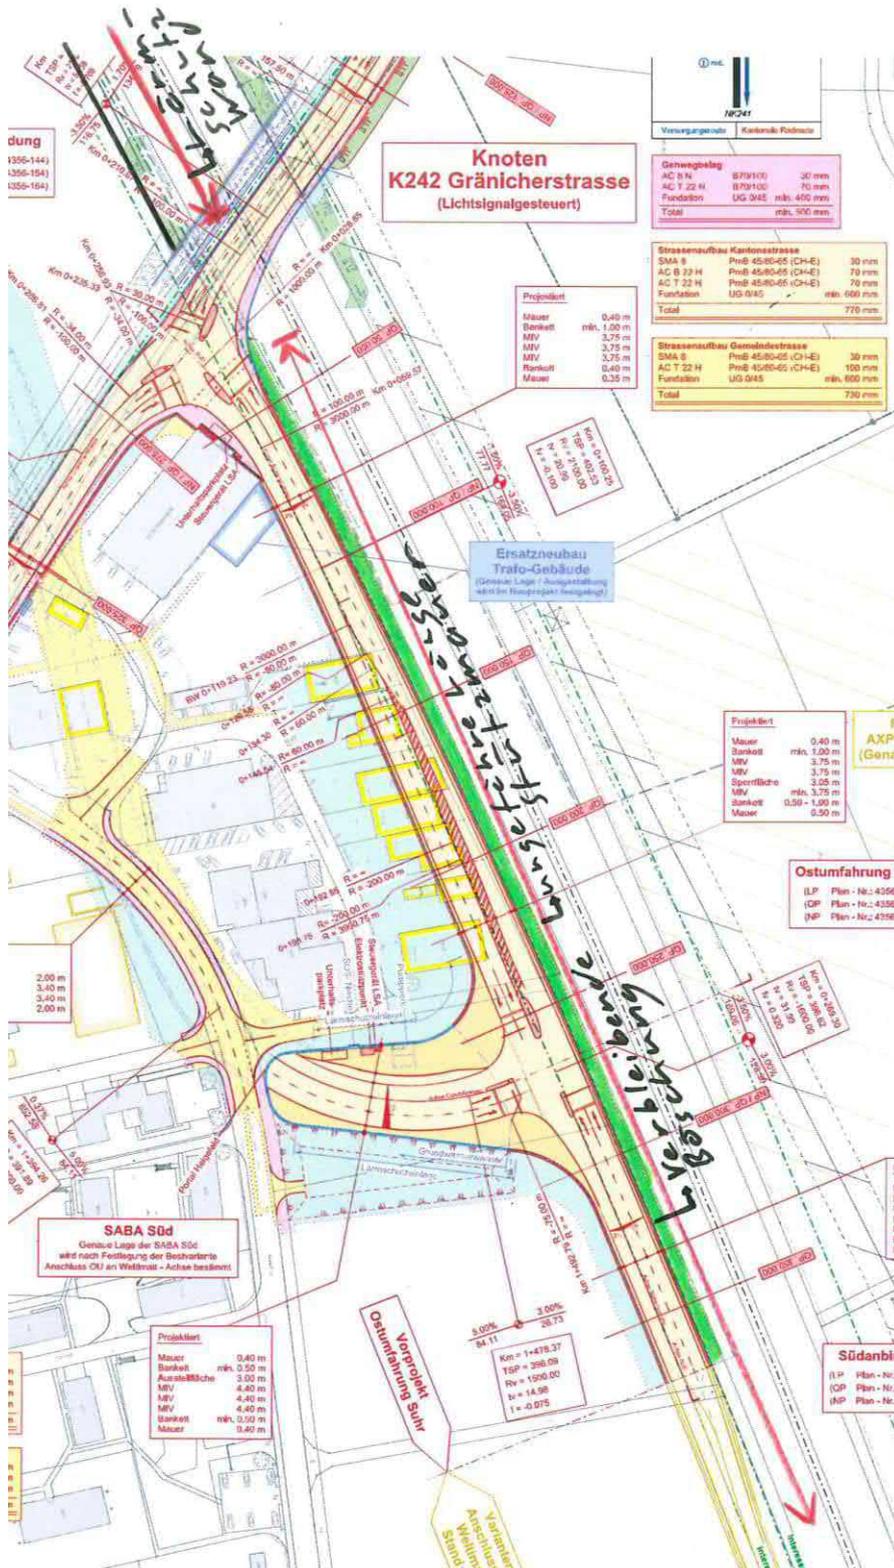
Situation mit Böschung westlich der Kantonsstrassenbrücke
